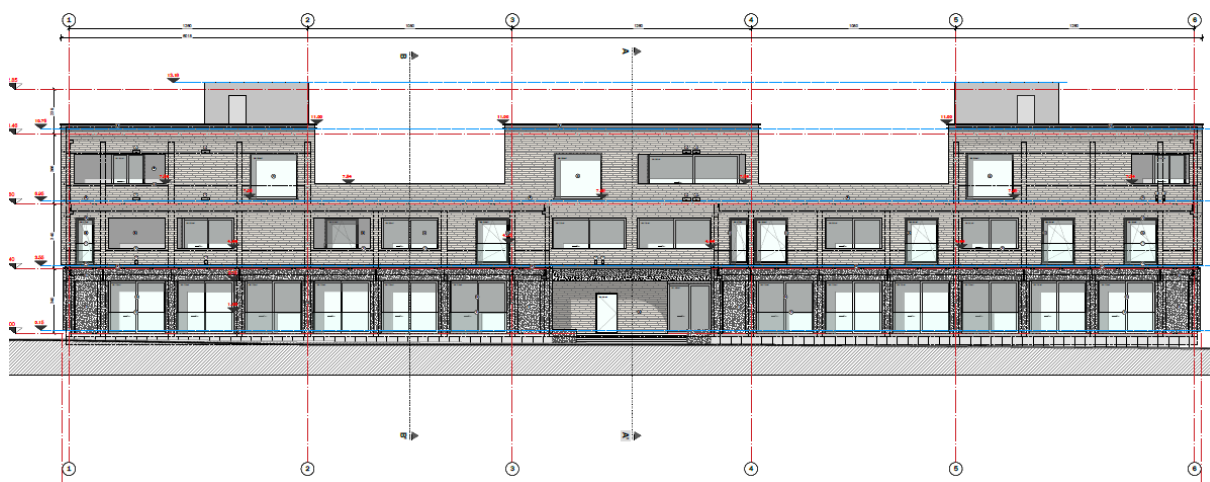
Extrait du plan de la façade avant (source : ARTER Architects)
